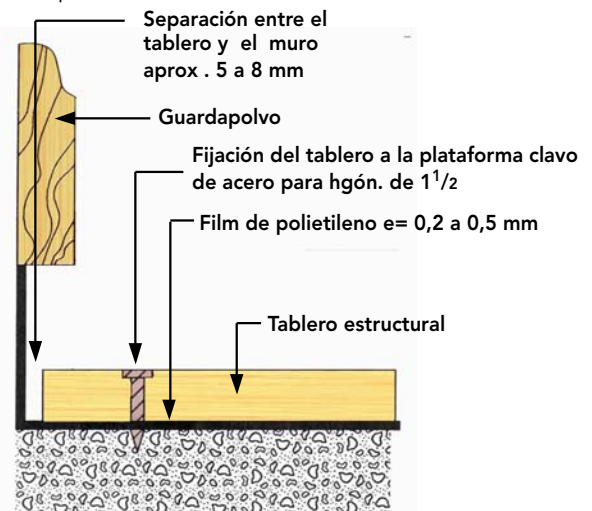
Fijación del tablero estructural a la plataforma de hormigón.
